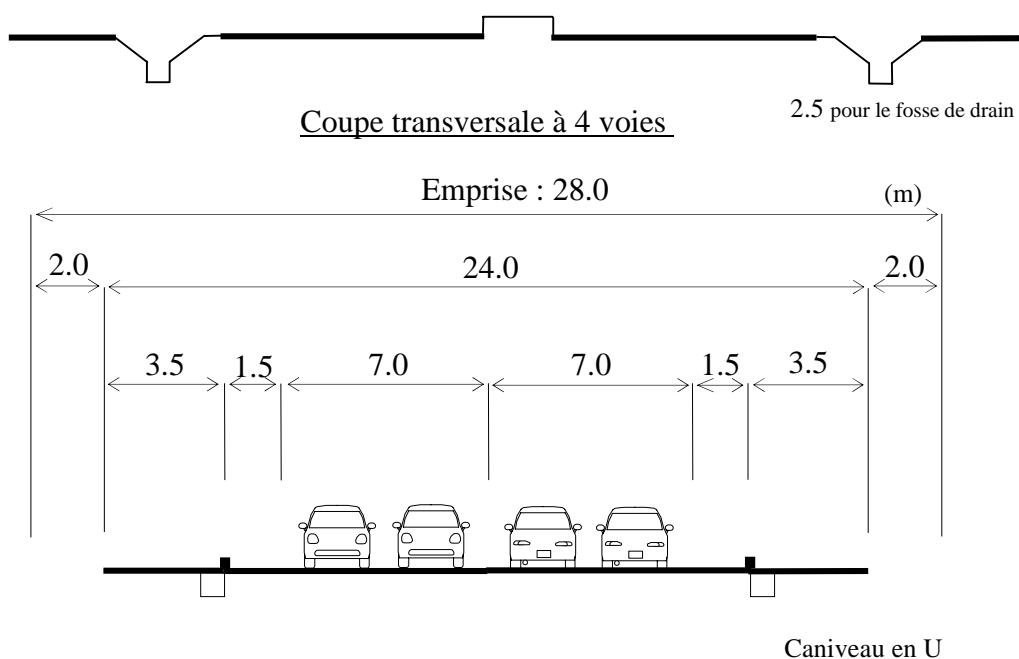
Coupe transversale de la ceinture à 4 voies
